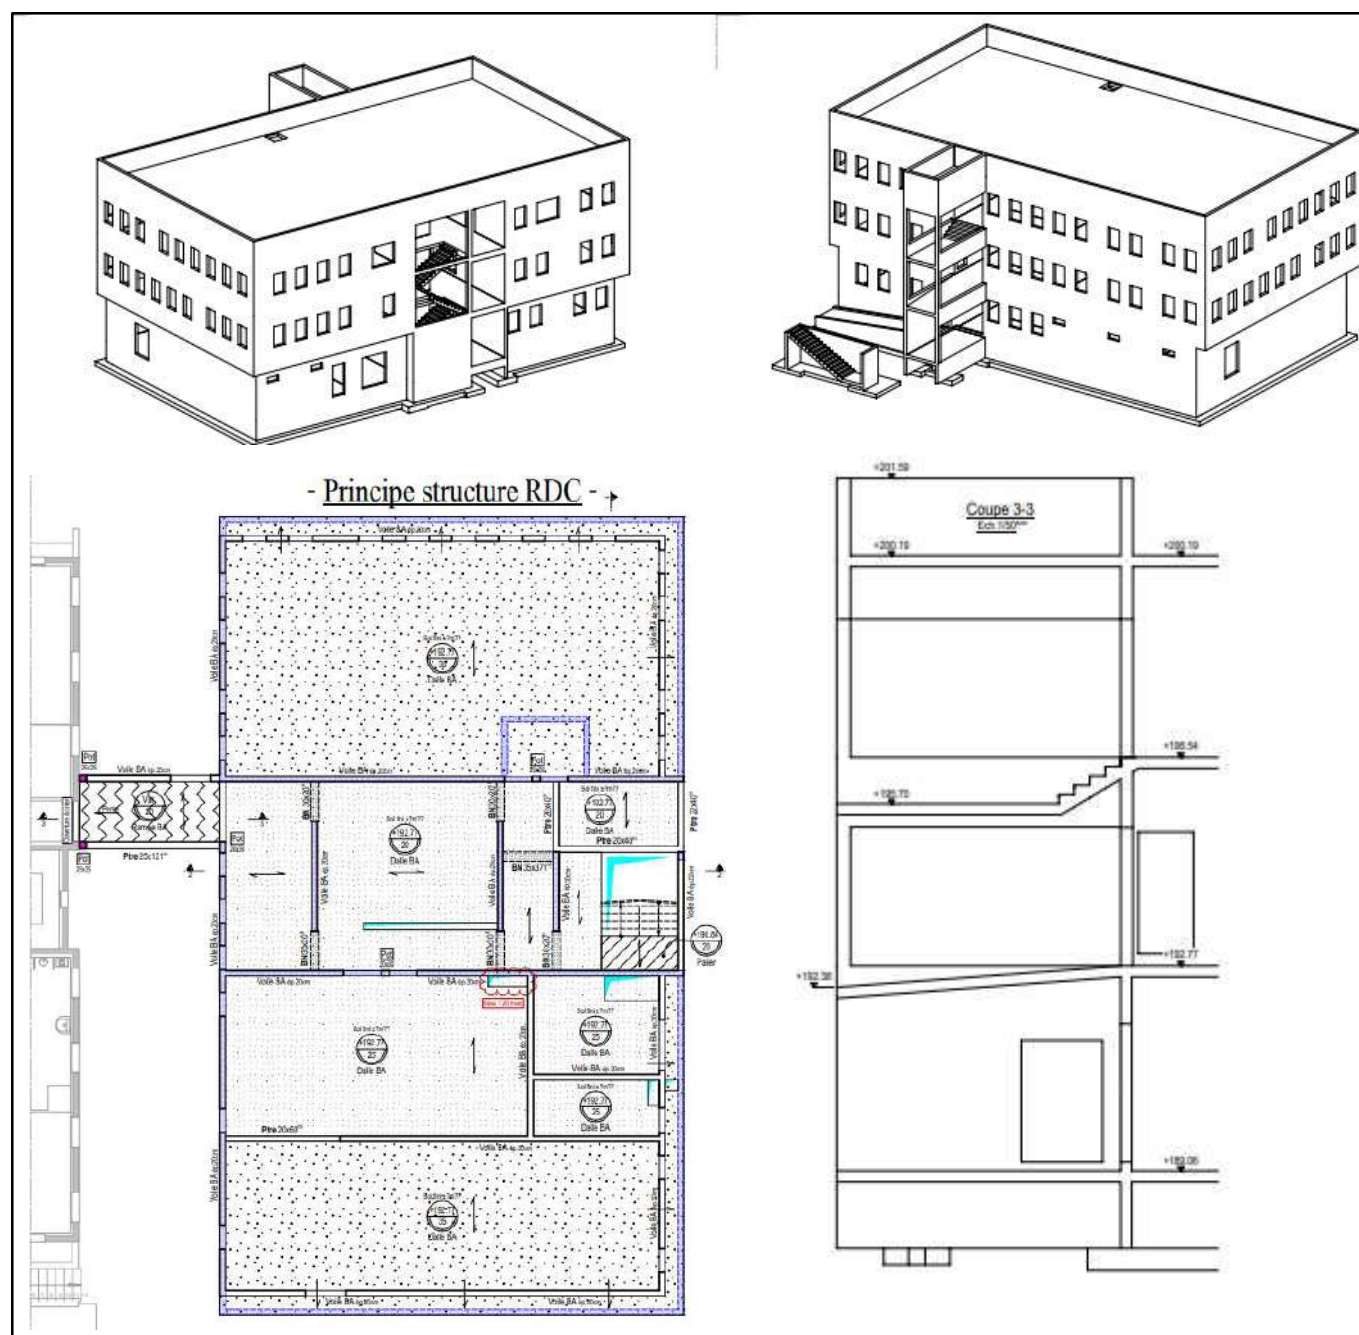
Plan RDC et coupe du projet d'extension du bâtiment 0203.
